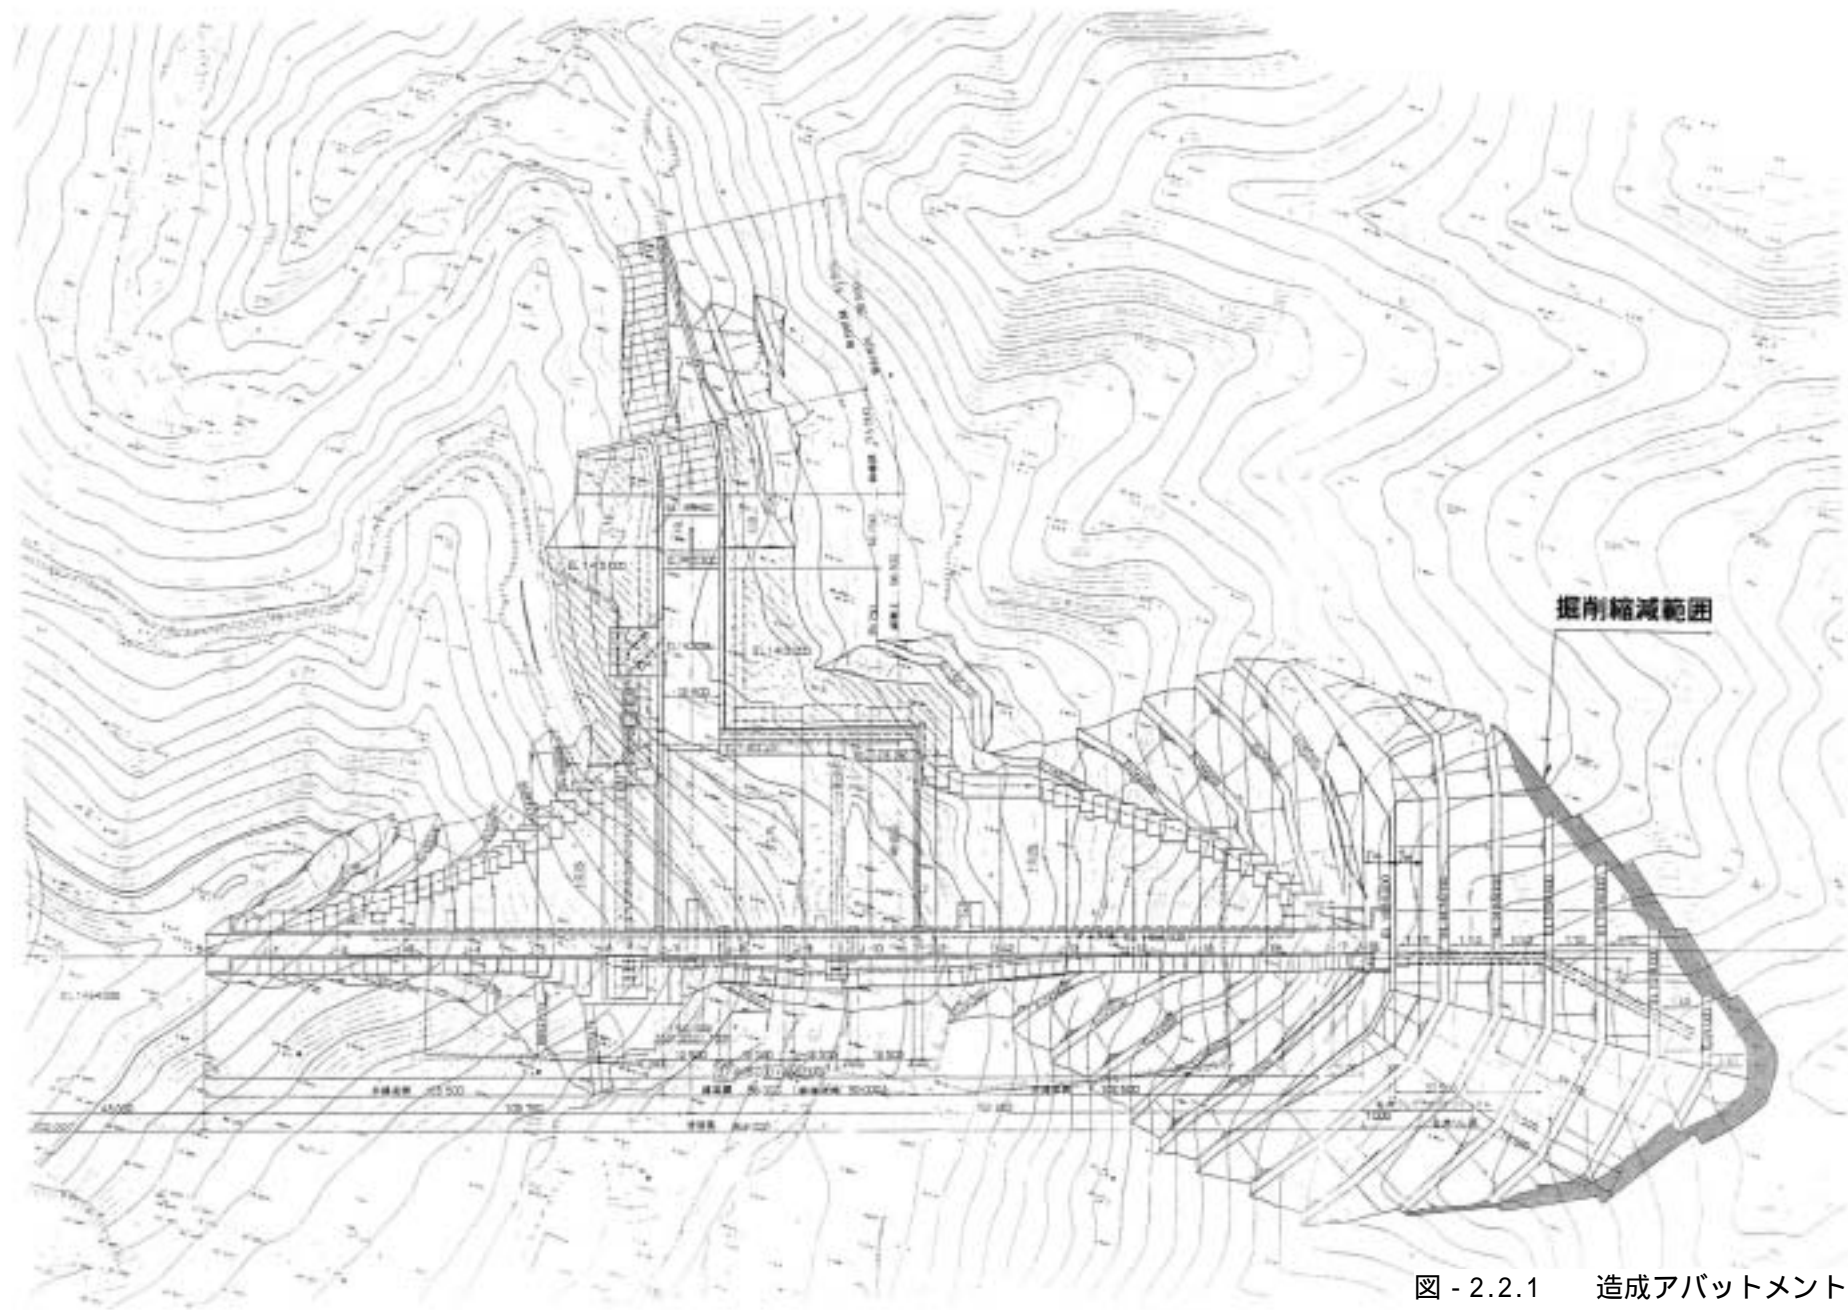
造成アバットメント適用による掘削範囲低減状況（平面図）
